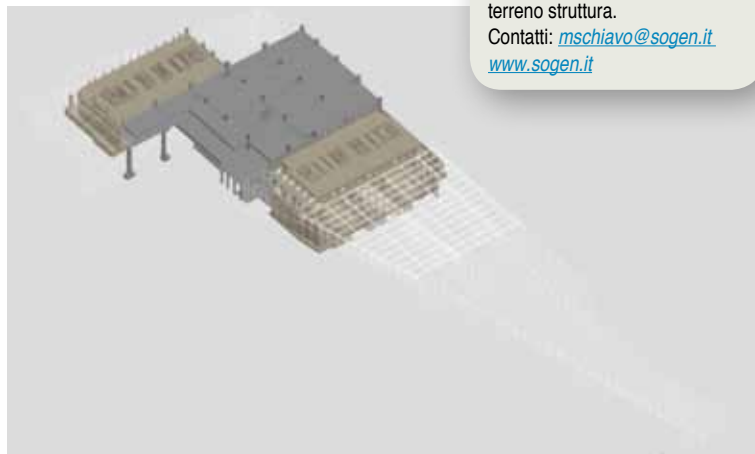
Complesso Garibaldi – Ricostruzione 3D delle strutture di fondazione del Complesso.
